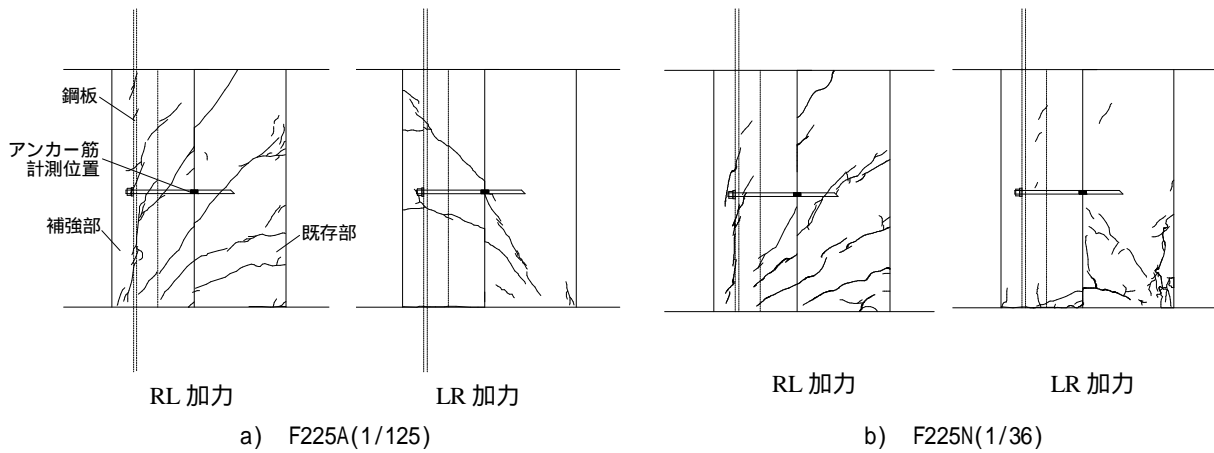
アンカー筋の計測位置とひび割れ状況の一例
